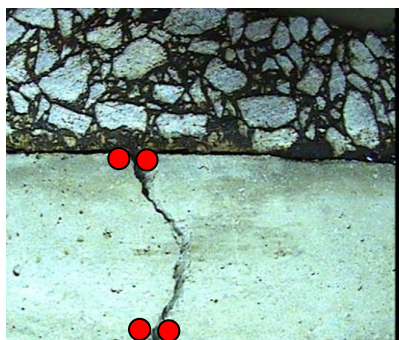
Dala cu conlucrare la fisura (db=3mm), fisură în dală
